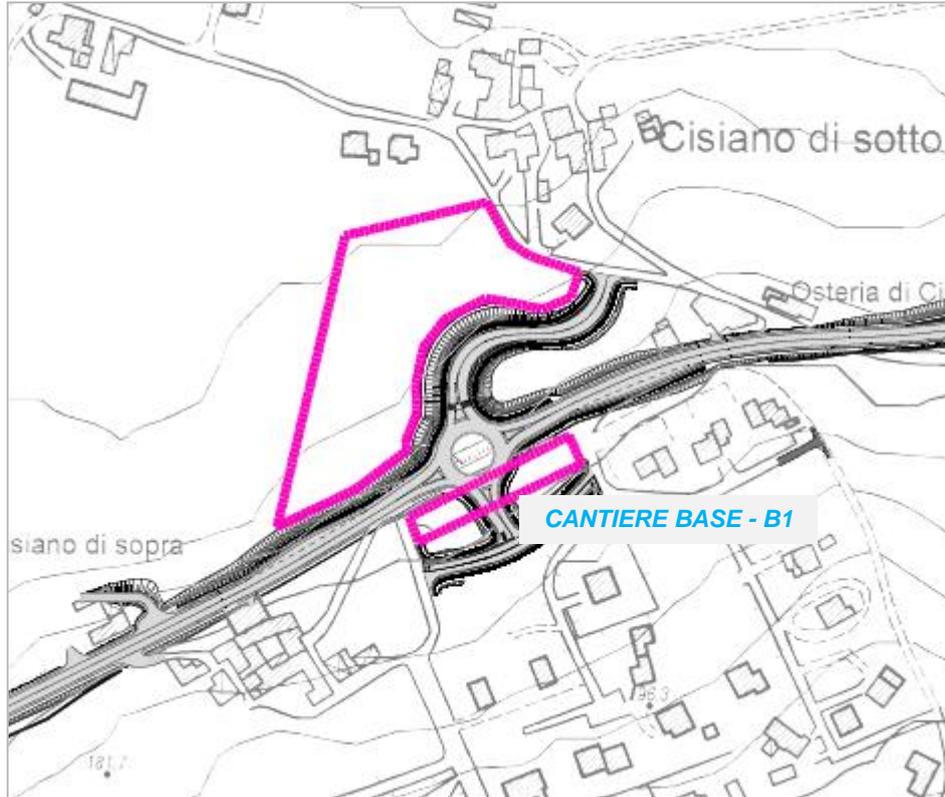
PLANIMETRIA CANTIERE BASE B1
